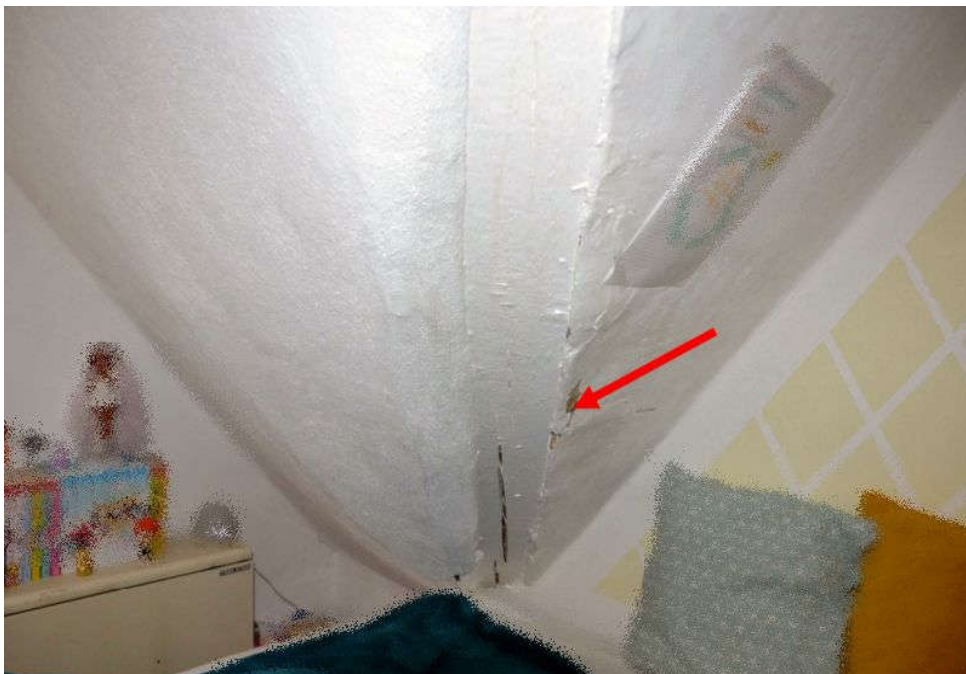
Dachgeschoss Feuchtigkeit, Farbe bröckelt ab (Pfeil)
